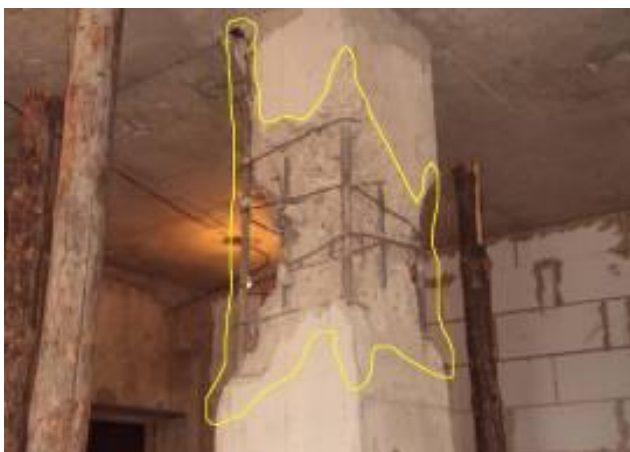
Разрушение бетона колонны К-Г-3с с оголением и коррозией арматуры
